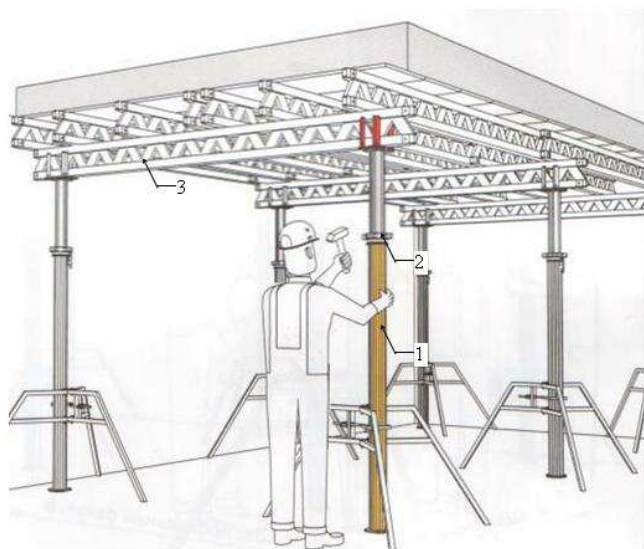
Опускание настила опалубки: 1-основная стойка;2-регулирующая гайка; 3-продольная балка
